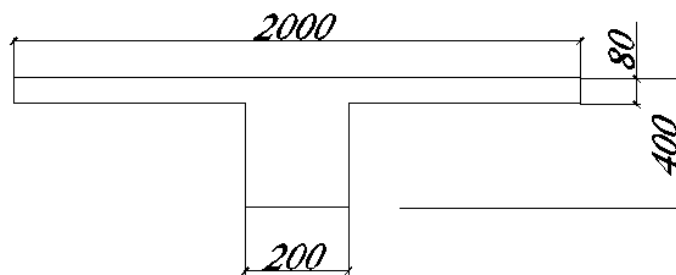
Розрахунковий переріз другорядної балки в прольоті
